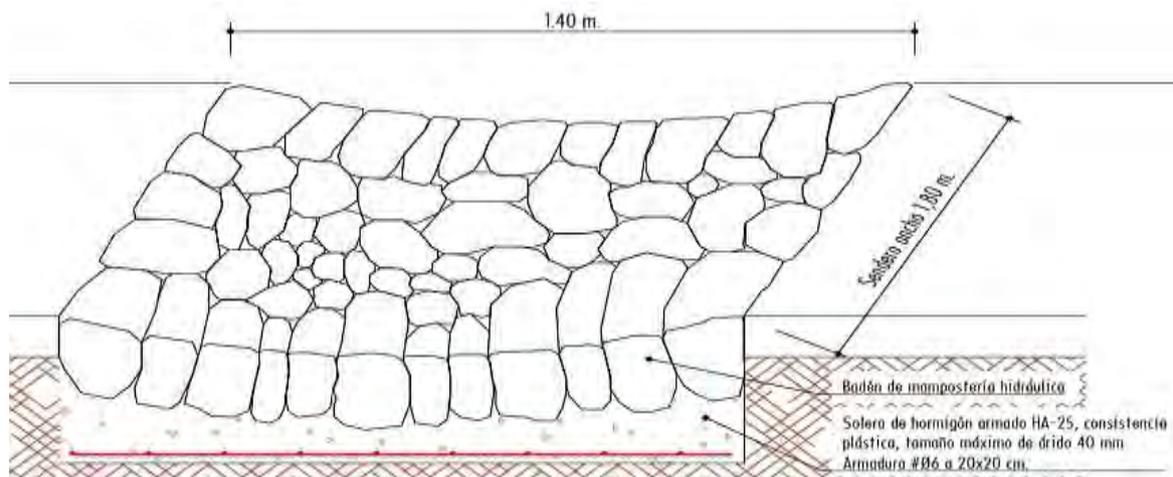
Vista en tres dimensiones de badén ejecutado con mampostería hidráulica. Fuente: elaboración propia
